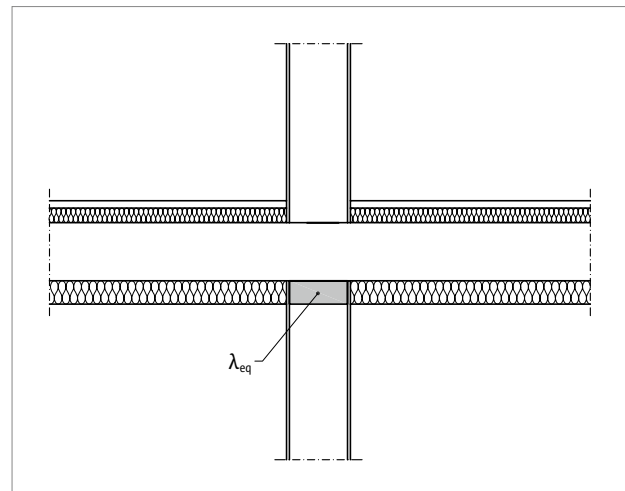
Darstellung einer Schnittzeichnung mit vereinfachtem Ersatzdämmkörper
